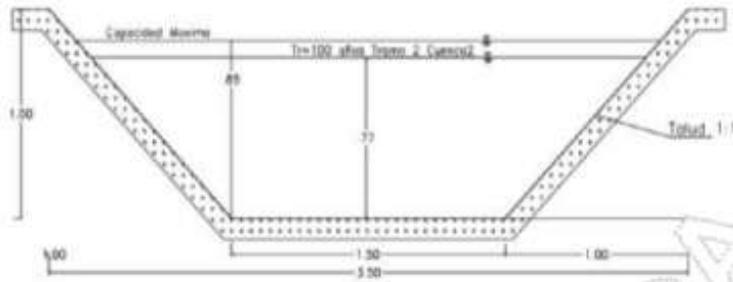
Tipo de la Obra:	Canal trapezoidal Tramo 1 cuenca 2
